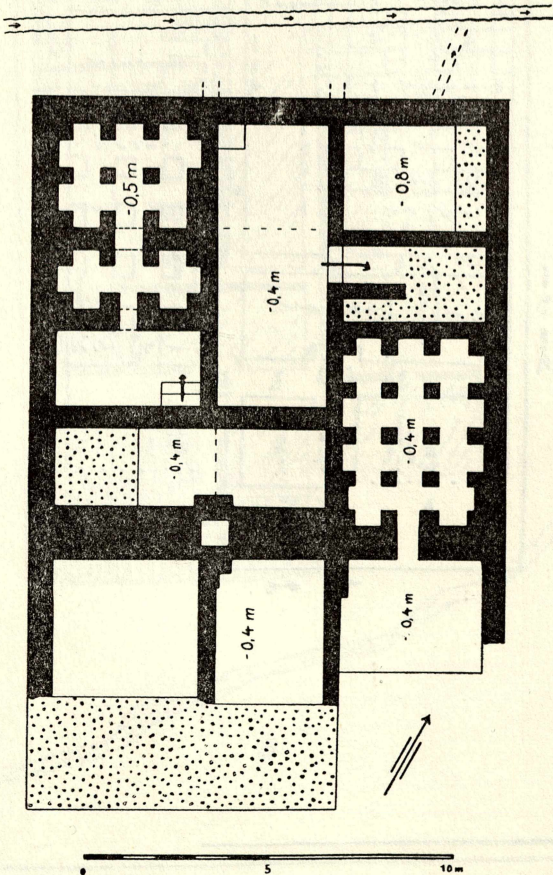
Karlstein. Gebäude I. Überarbeiteter Grundrißplan. M 1:200.
